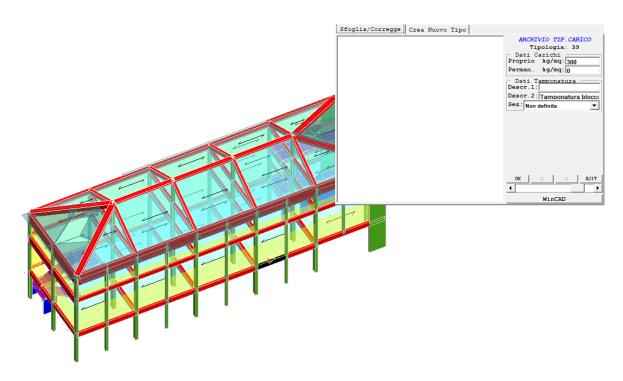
Assegnazione del carico delle tamponature dall'input impalcati
